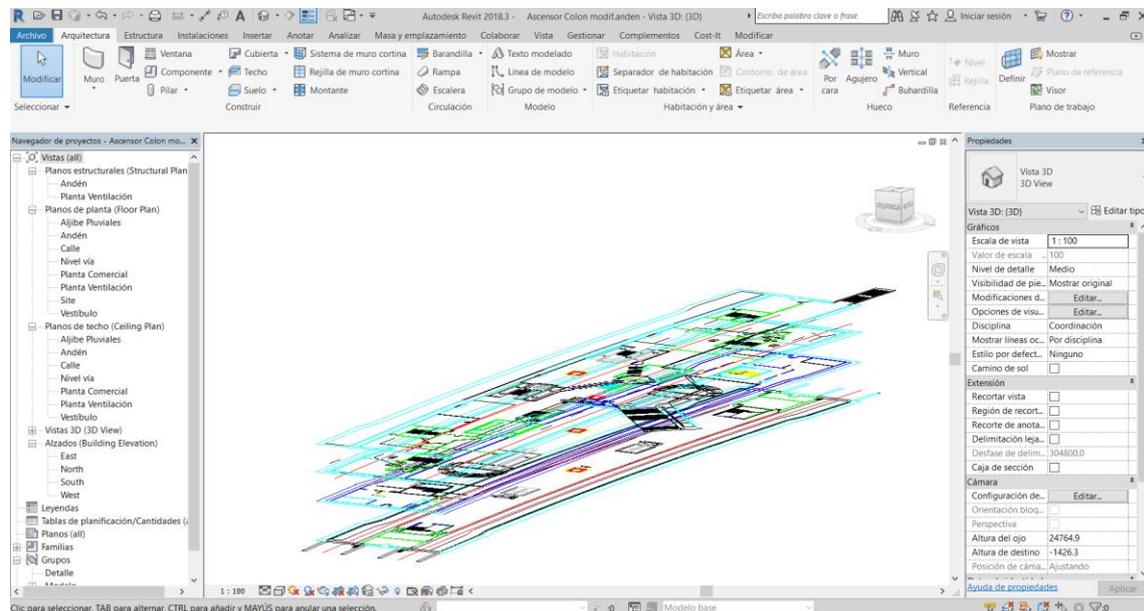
Vista en 3D de las plantas importadas de la estación de metro de Colón en Revit
